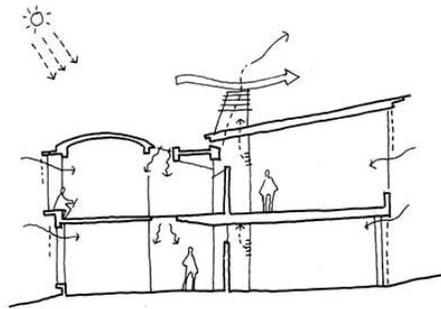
Referente técnico 2 - Haute Vallée School - Planos
